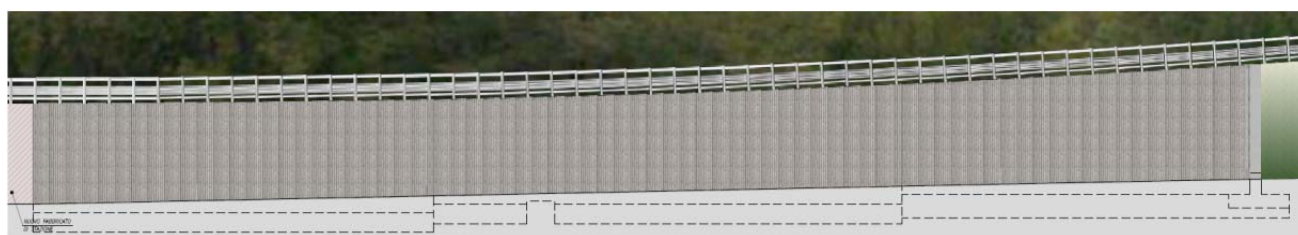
Prospetto del muro A (estratto dalla tavola H.01.01.0.0).
